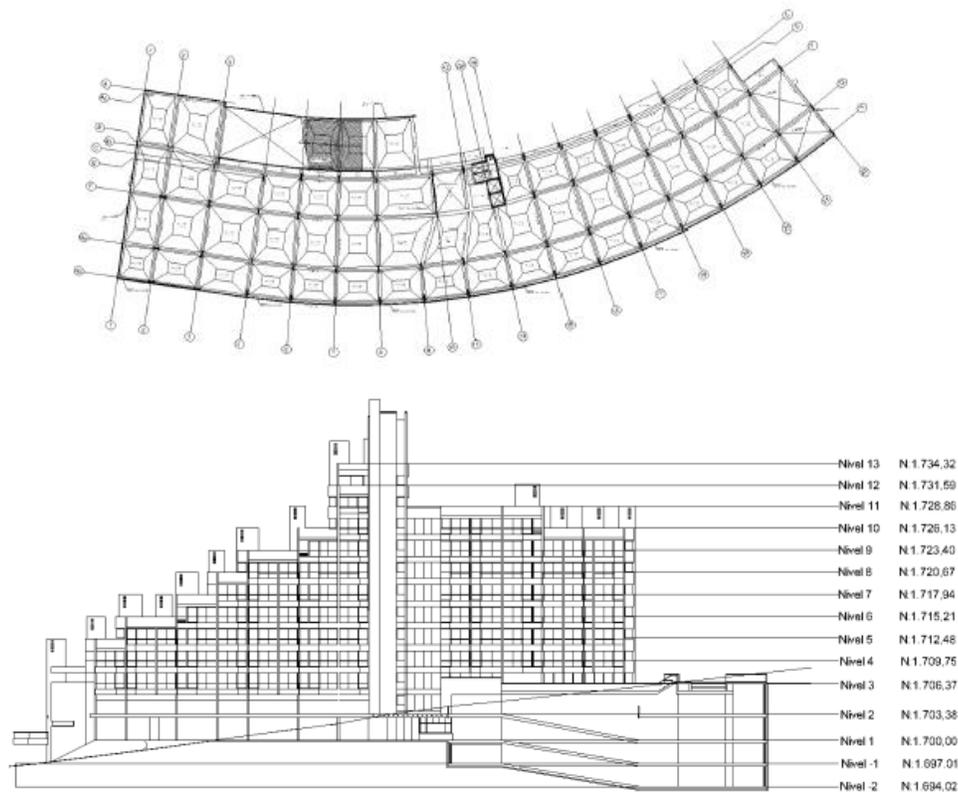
Configuración estructural en planta del piso 2 y en altura. Tomado de los planos iniciales
